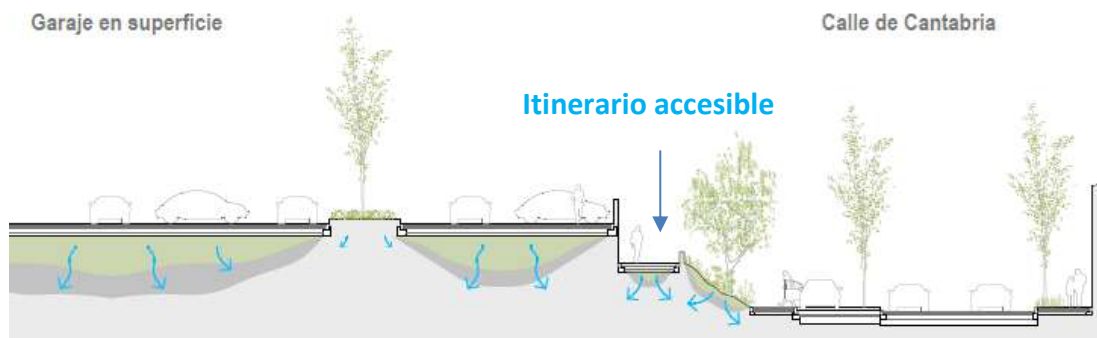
Sección por el aparcamiento de calle Cantabria.
